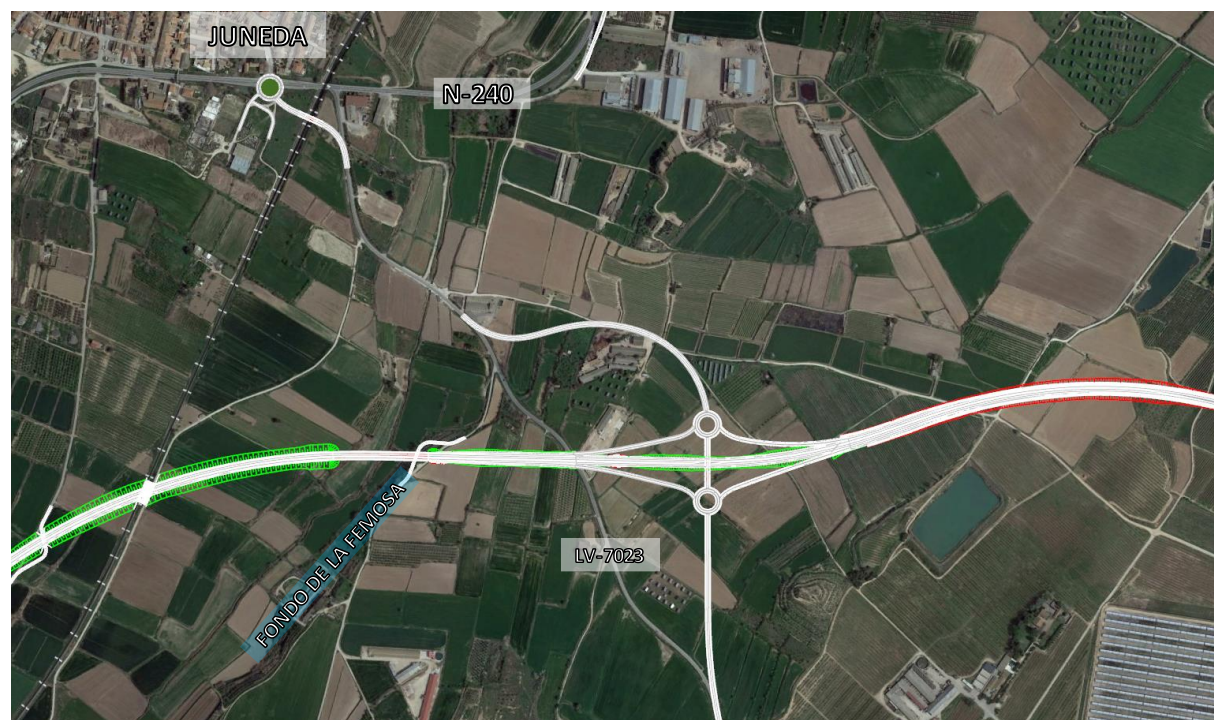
Enlace de Juneda Sur (con carretera LV-7023). Alternativa D3
